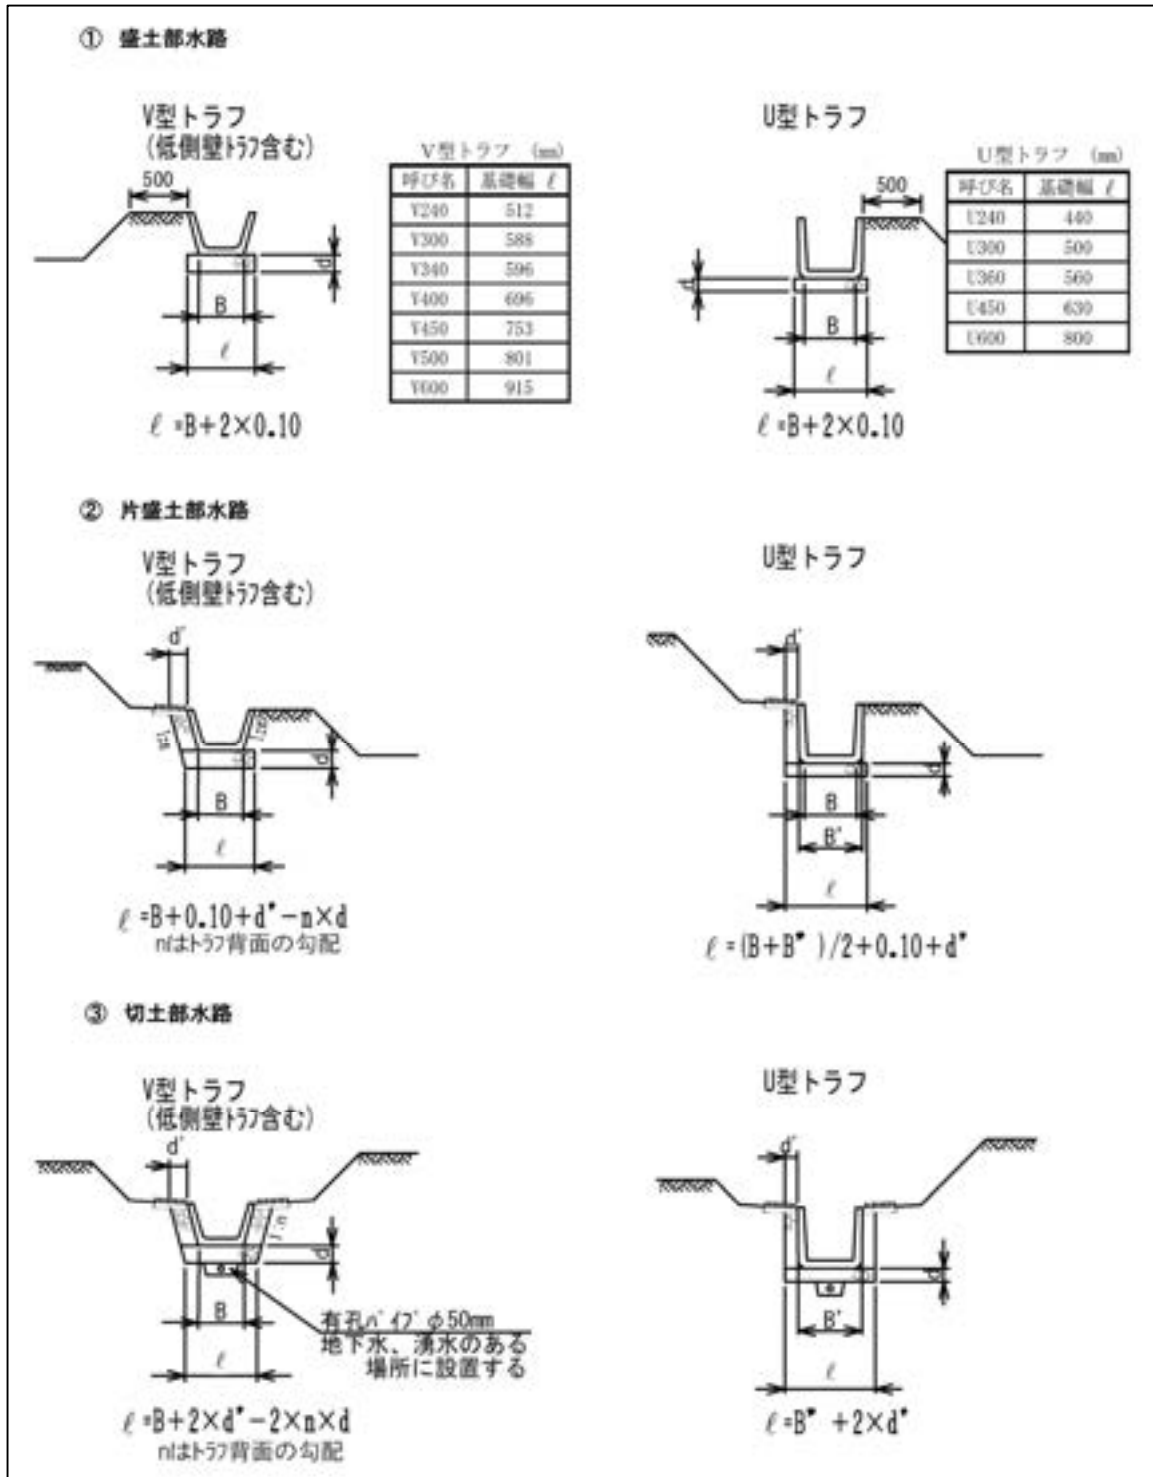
コンクリートトラフ水路の基礎工の形状
